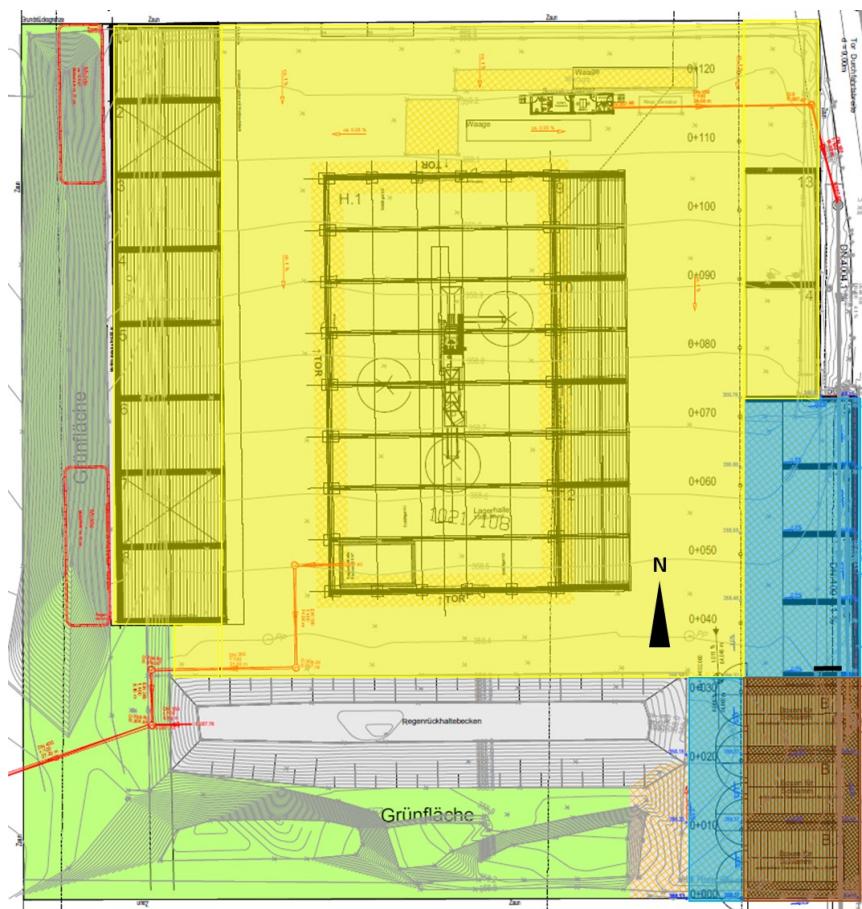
Lageplan mit unterschiedlich geplanten Teilflächen
